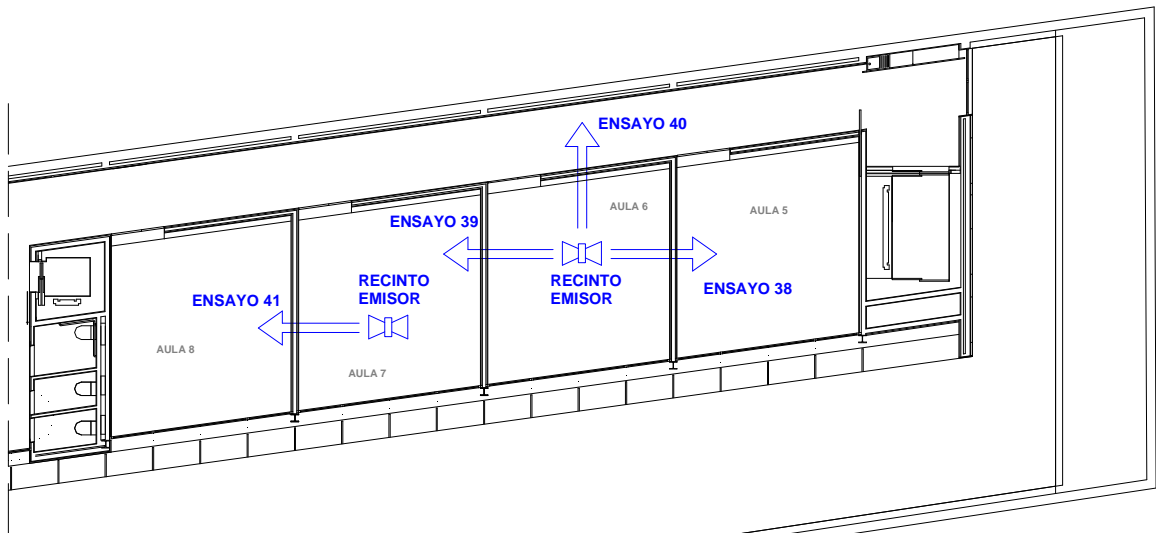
Plano de ubicación de los ensayos 38 a 4 (planta primera).
